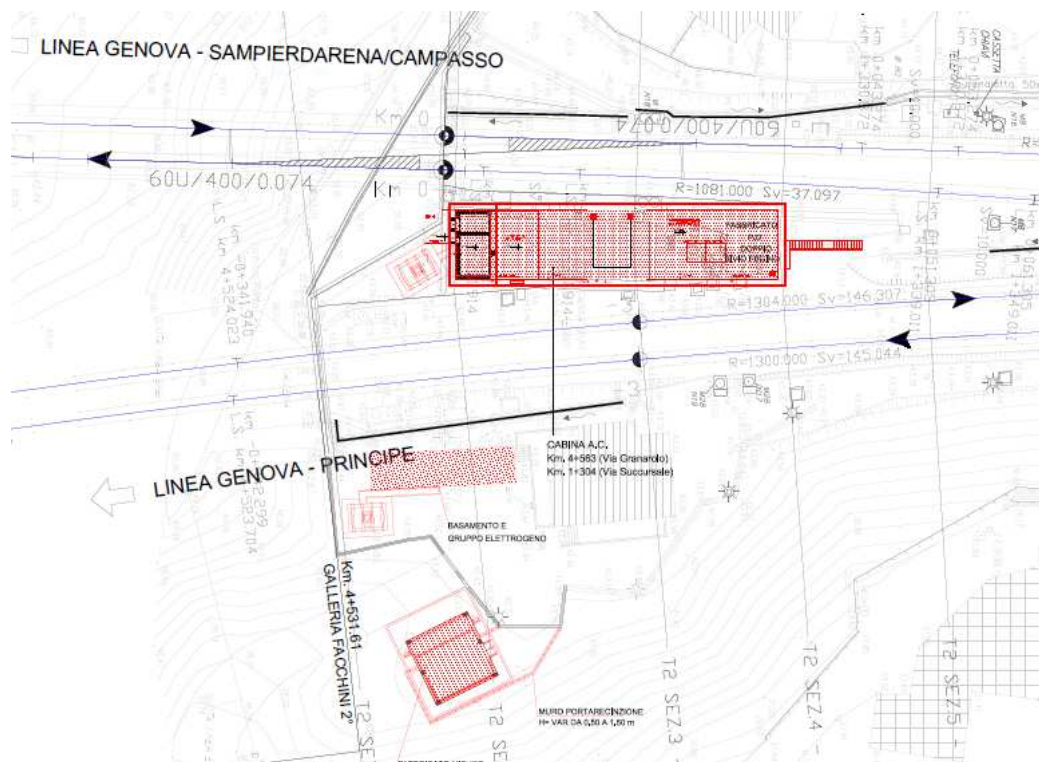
WBS IN91 – Stralcio planimetrico del piazzale – In rosso le opere previste
